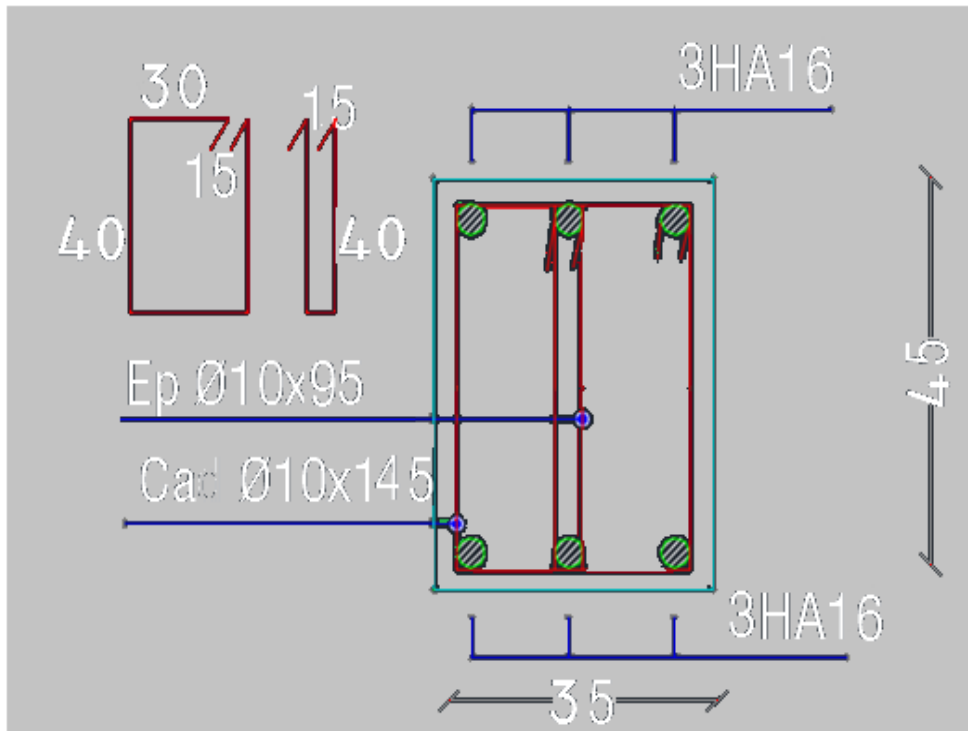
Ferrailage des poutres principales au niveau de travée de 8<sup>ème</sup> à 13<sup>ème</sup> étage.
